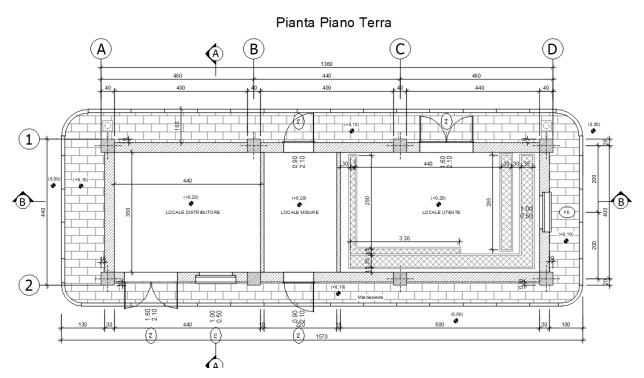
Edificio ENEL - Pianta architettonica del piano terra
